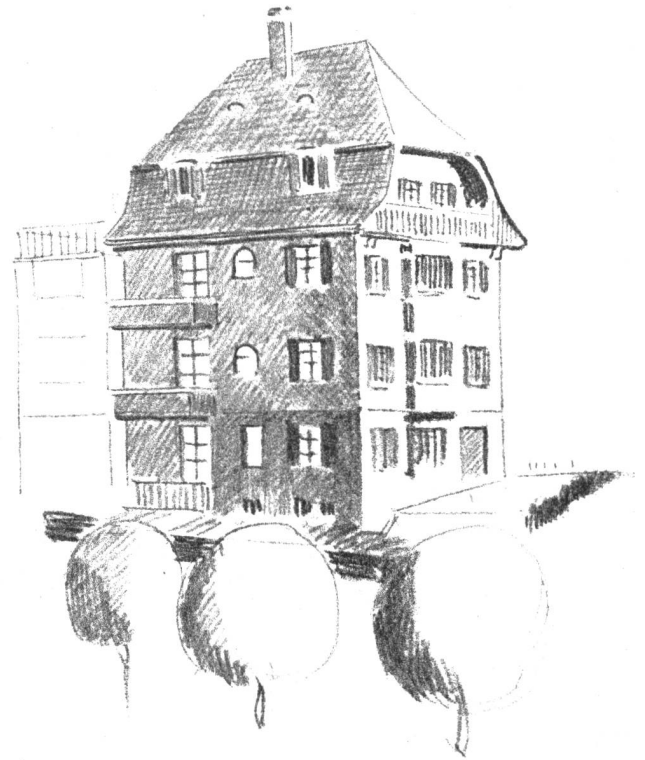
u. 10. Nicht gerade vorbildliche Bauten mit vier und mehr bewohnbaren Geschossen bedrohten das Stadtbild ernstlich. Dank der im Jahre 1927 in Kraft gesetzten Bauordnung ist die Art der zukünftigen Bebauung geregelt worden. Im alten Städtchen ist die Höhe der Bauten auf vier bewohnbare Geschosse (Erdgeschoss und Dachstock inbegriffen) beschränkt. Bestehende Häuser, die weniger als vier Geschosse aufweisen, dürfen nur dann erhöht werden, wenn diese Massnahmen nach dem Urteil Sachverständiger das Stadtbild nicht beeinträchtigen. Das Aeussere muss in bezug auf Bauart, Bauform und Farbe so beschaffen sein, dass sich die Bauten taktvoll ins Orts- und Landschaftsbild eingliedern.
